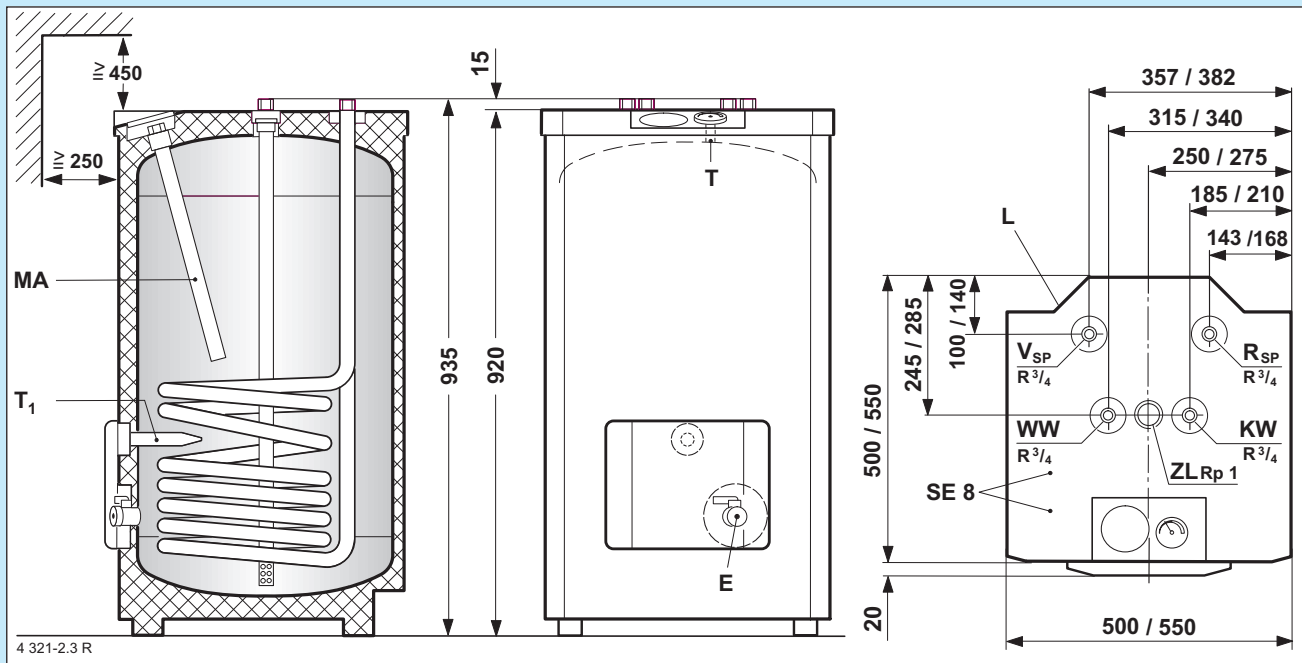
Bau- und Anschlussmaße ST 120-1 E. und ST 160-1 E. (Maßangaben hinter einem Schrägstrich beziehen sich auf die größere Speicherausführung)
